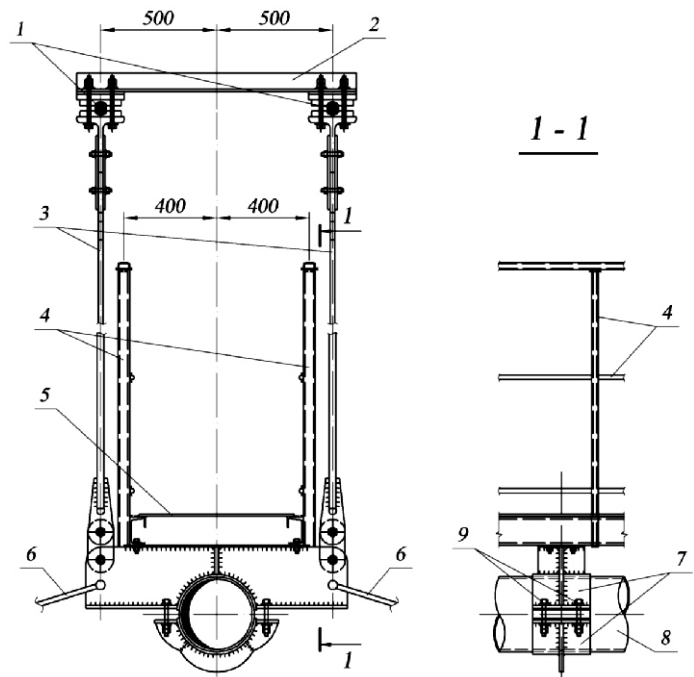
Рекомендуемая конструкция смотрового мостика и узлов крепления трубы газопровода к подвескам и ветровым оттяжкам:
